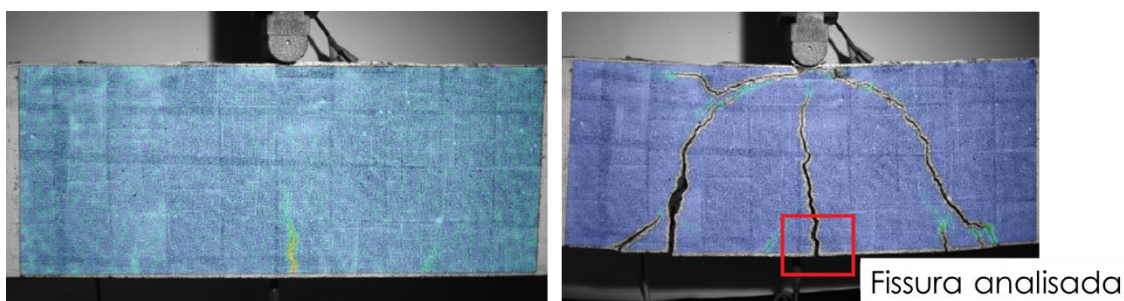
Viga V1-REF - Início da fissuração e na ruptura
